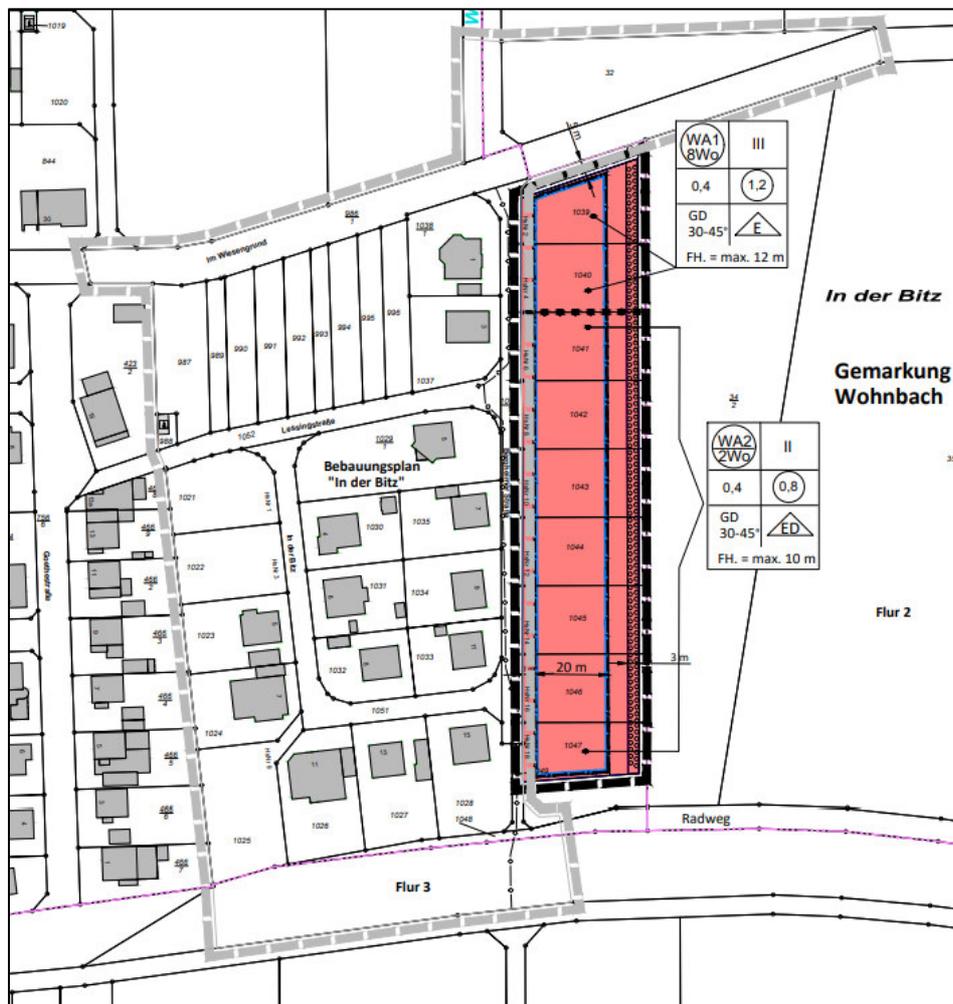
Entwurf zum Bebauungsplan „In der Bitz“ 2. Bauabschnitt
